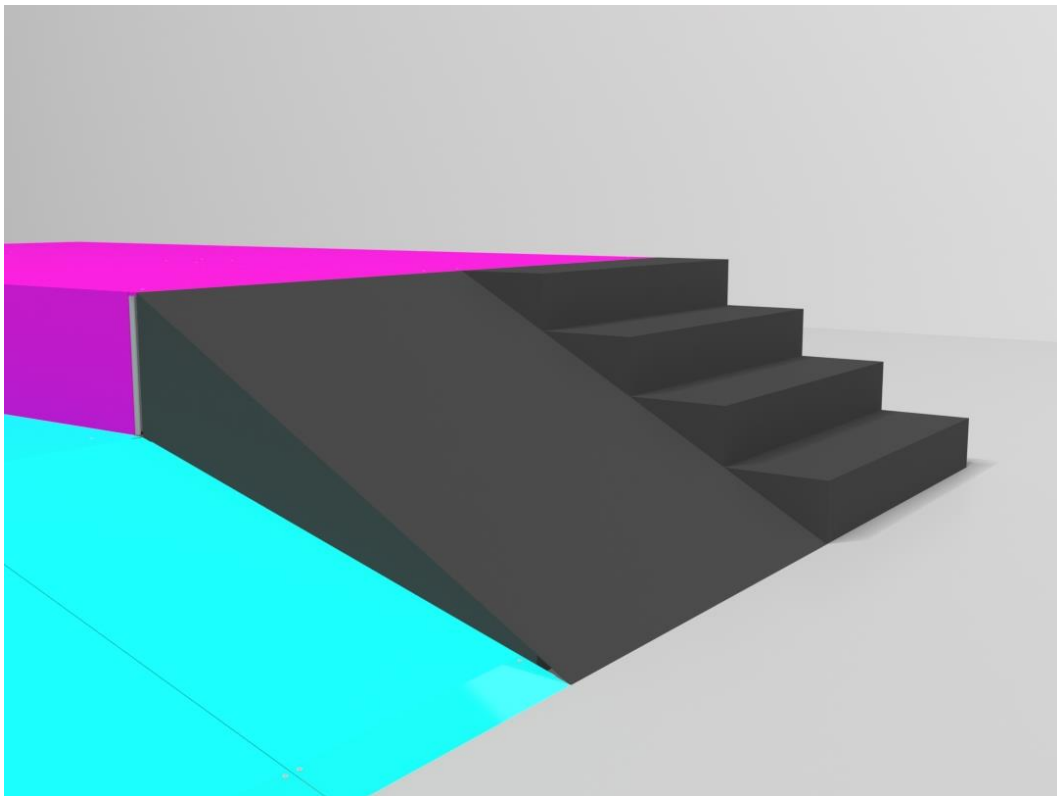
Módulo *kicker* alto y módulo escaleras
